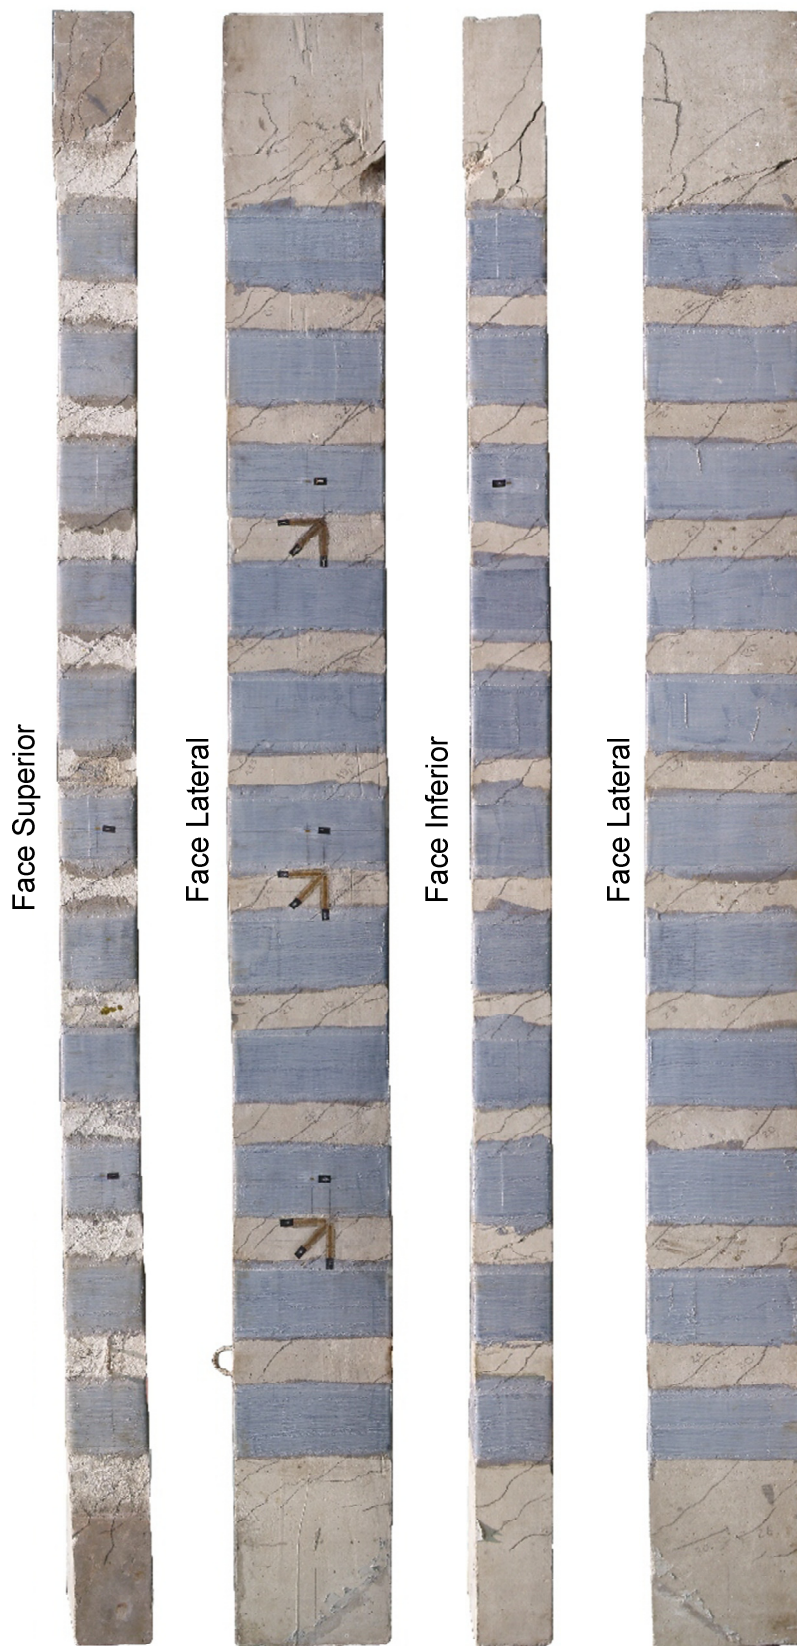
Configuração das fissuras da viga VT2.
